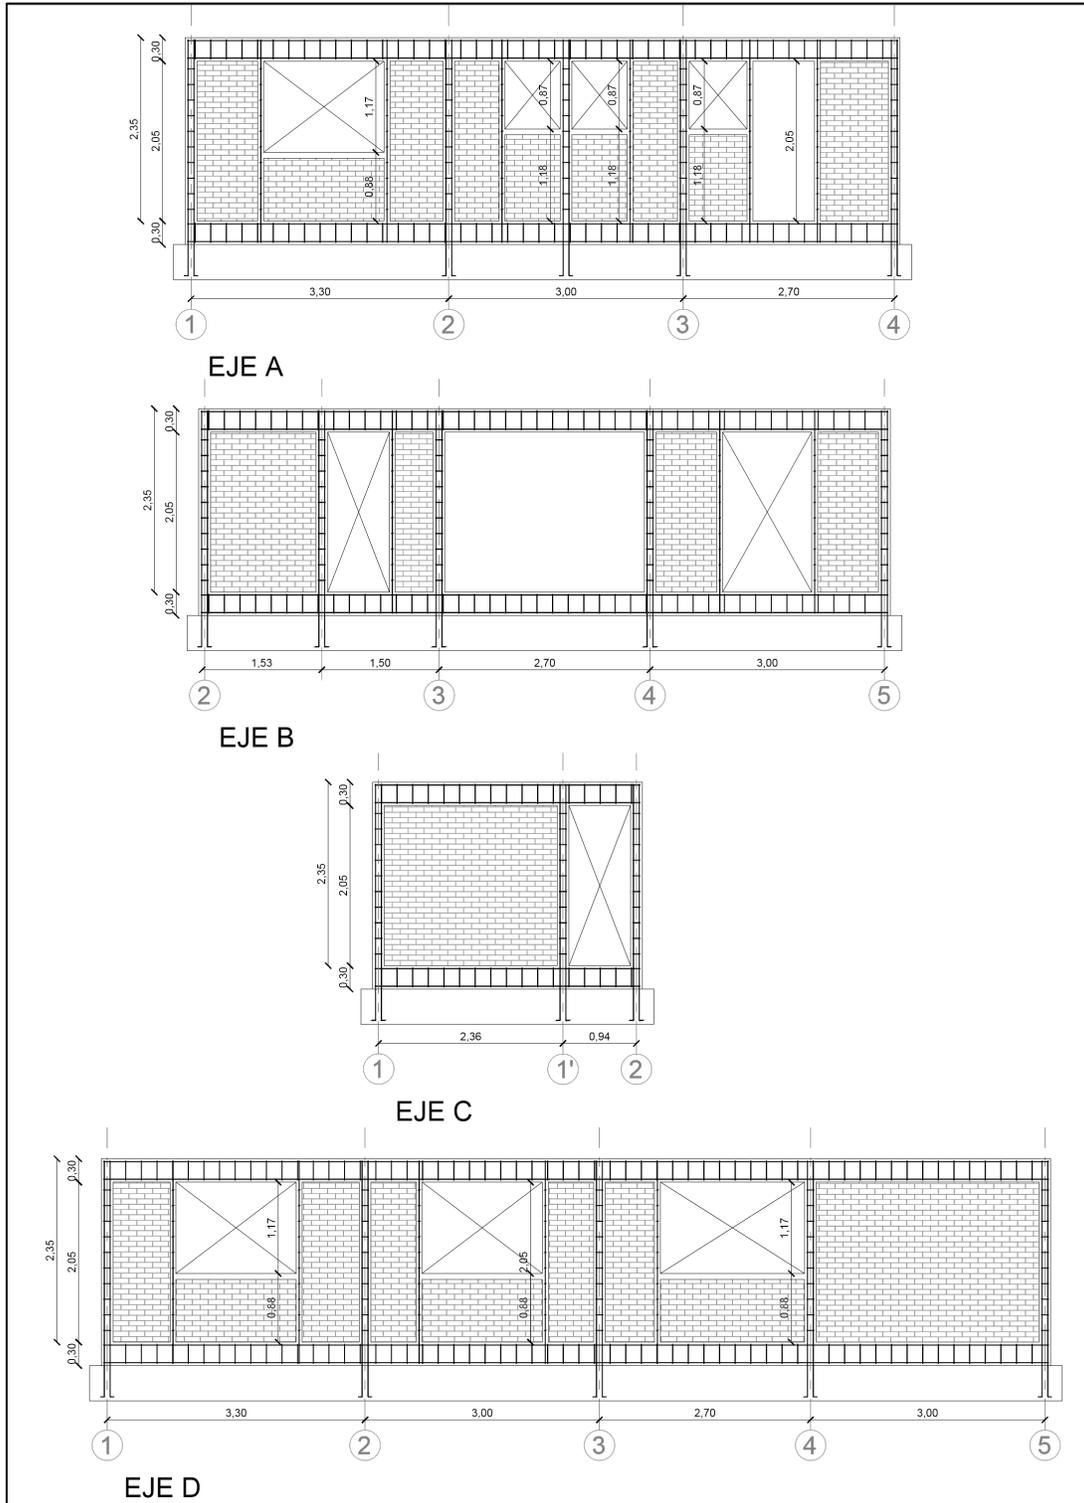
Elevaciones de estructuras modelo de albañilería confinada
